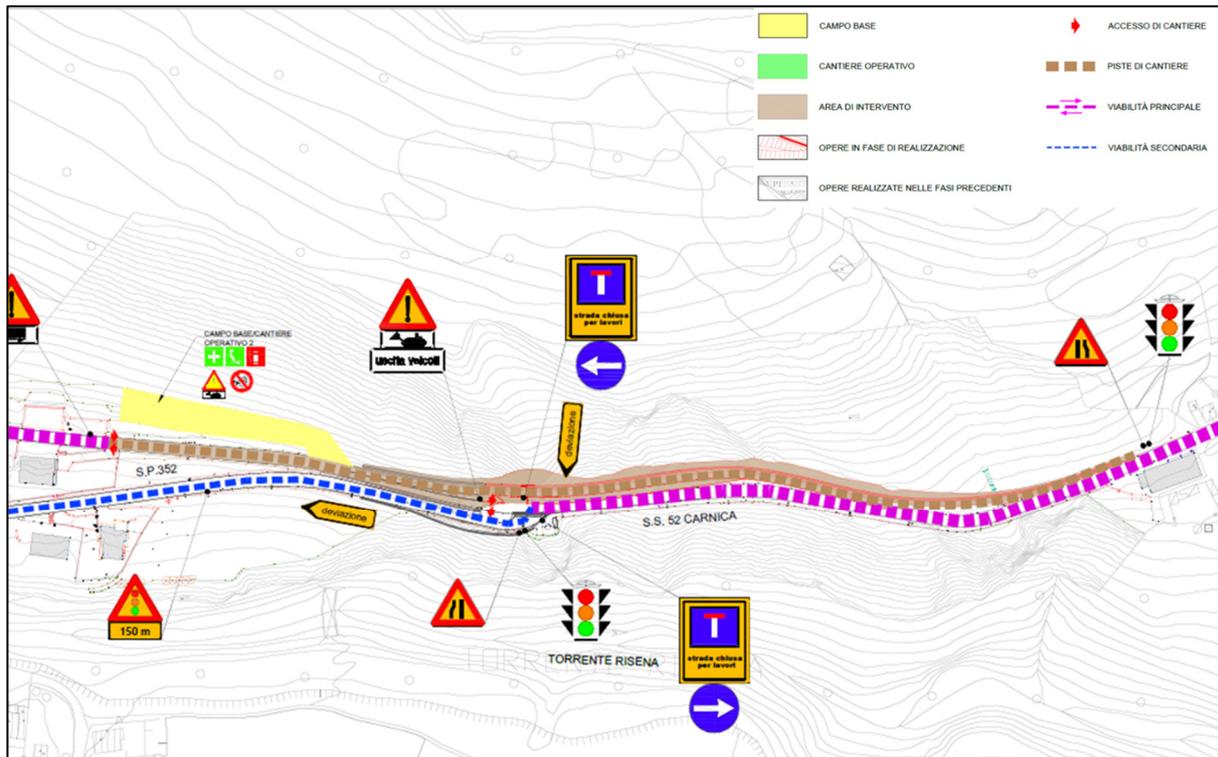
Cantierizzazione Fase 3 – Estratto elab. T00CA00CANPL02A
